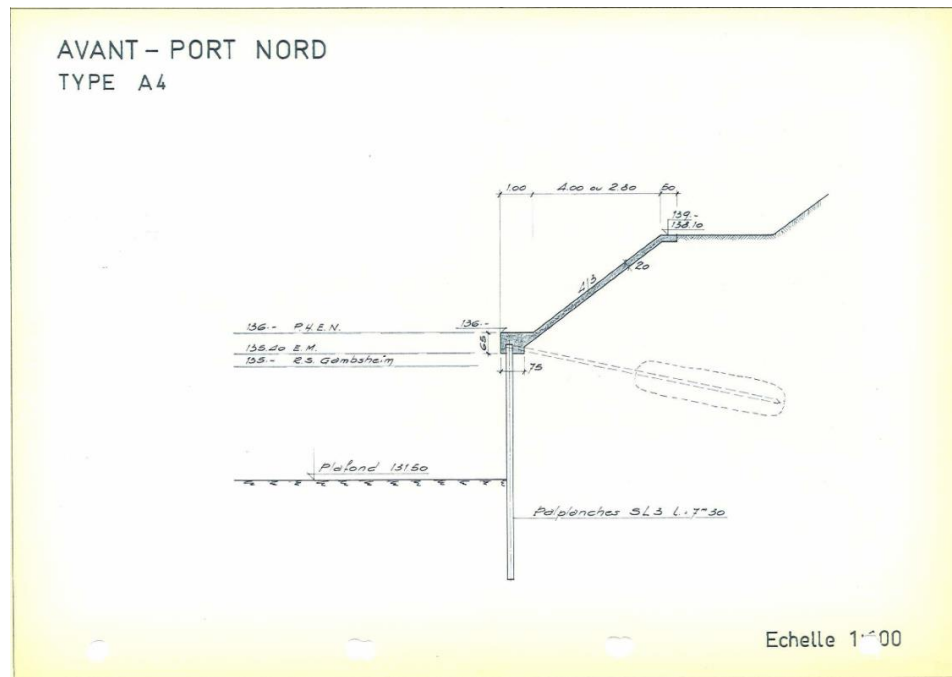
Soutènement par un rideau palplanche tirant en rive gauche
